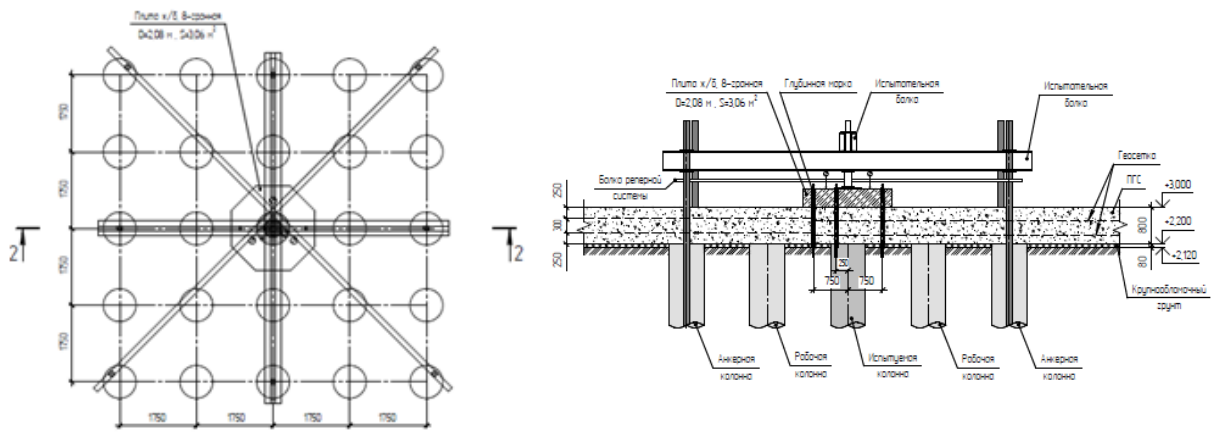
Схема испытания укрепленного грунта штампом для схем укрепления № 2 – 4.
